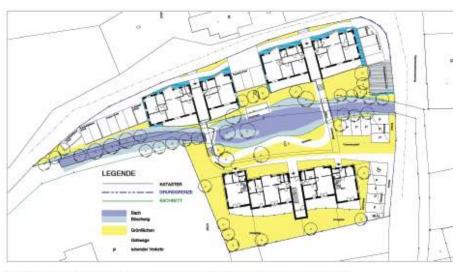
Lageplan der Gesamtanlage (Büro Mikula + Partner 2006)
